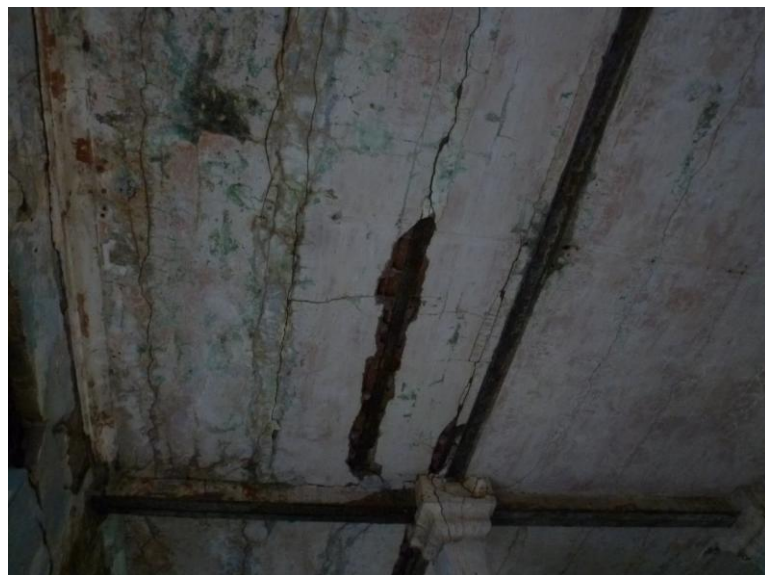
Etat de la sous-face du plancher du 1er étage
